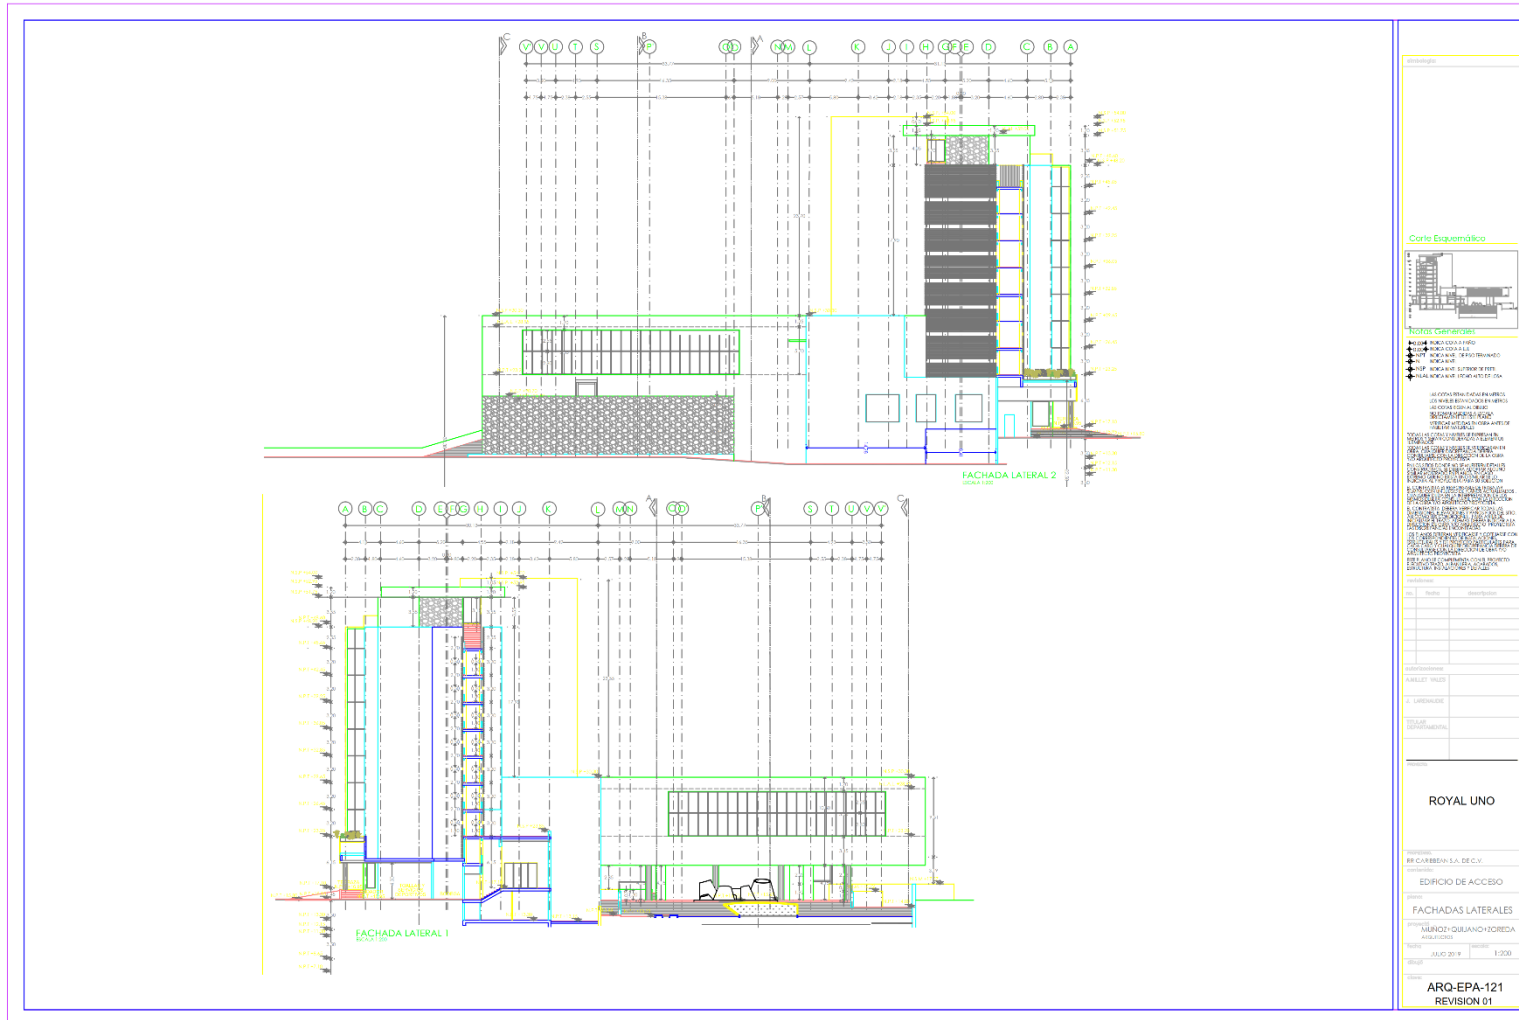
Edificio D y de acceso, Fachada lateral. Anexo C-7.
